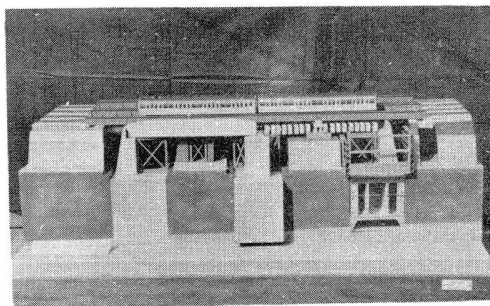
工事桁で仮受けして下部構造とPC横桁を施工する。
